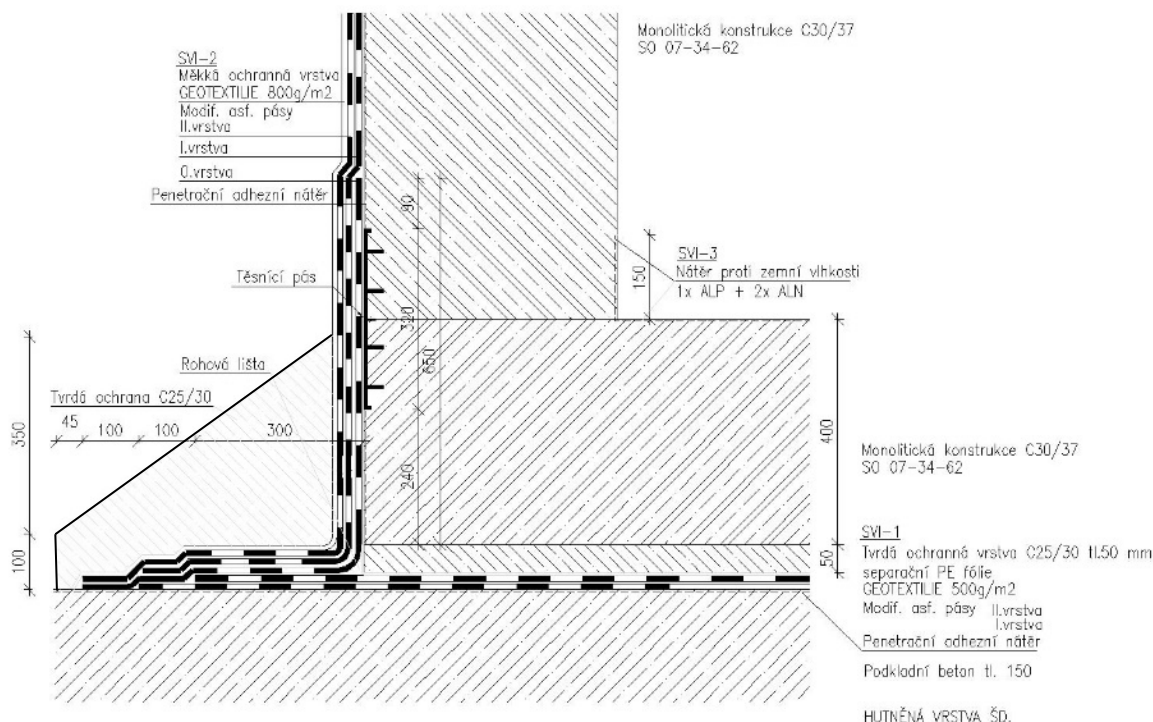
Detaily spoje SVI v dilataci – nová konstrukce/nová konstrukce
